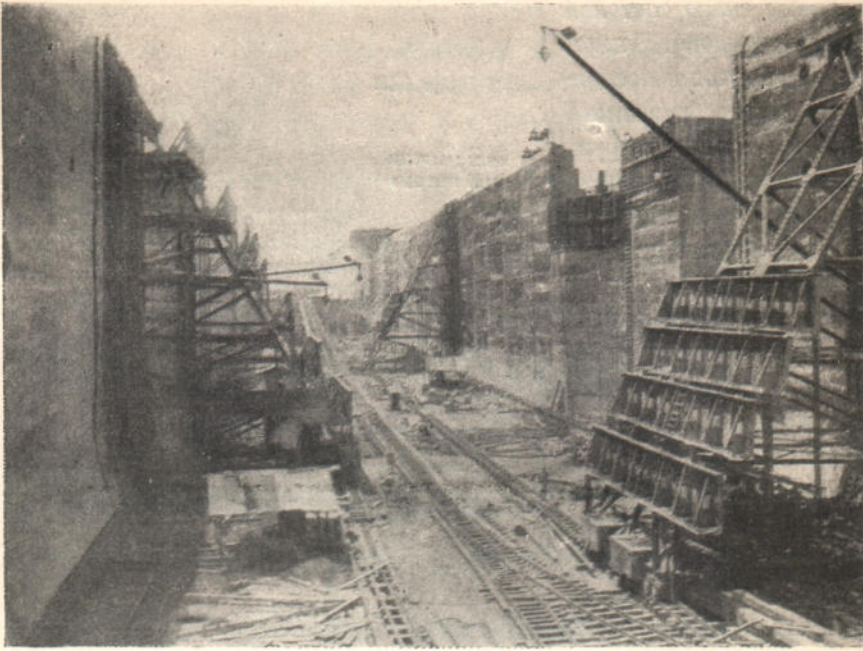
Металлическія сквозныя башни, поддерживающія формы для отливки шлюзовыхъ стѣнъ.
